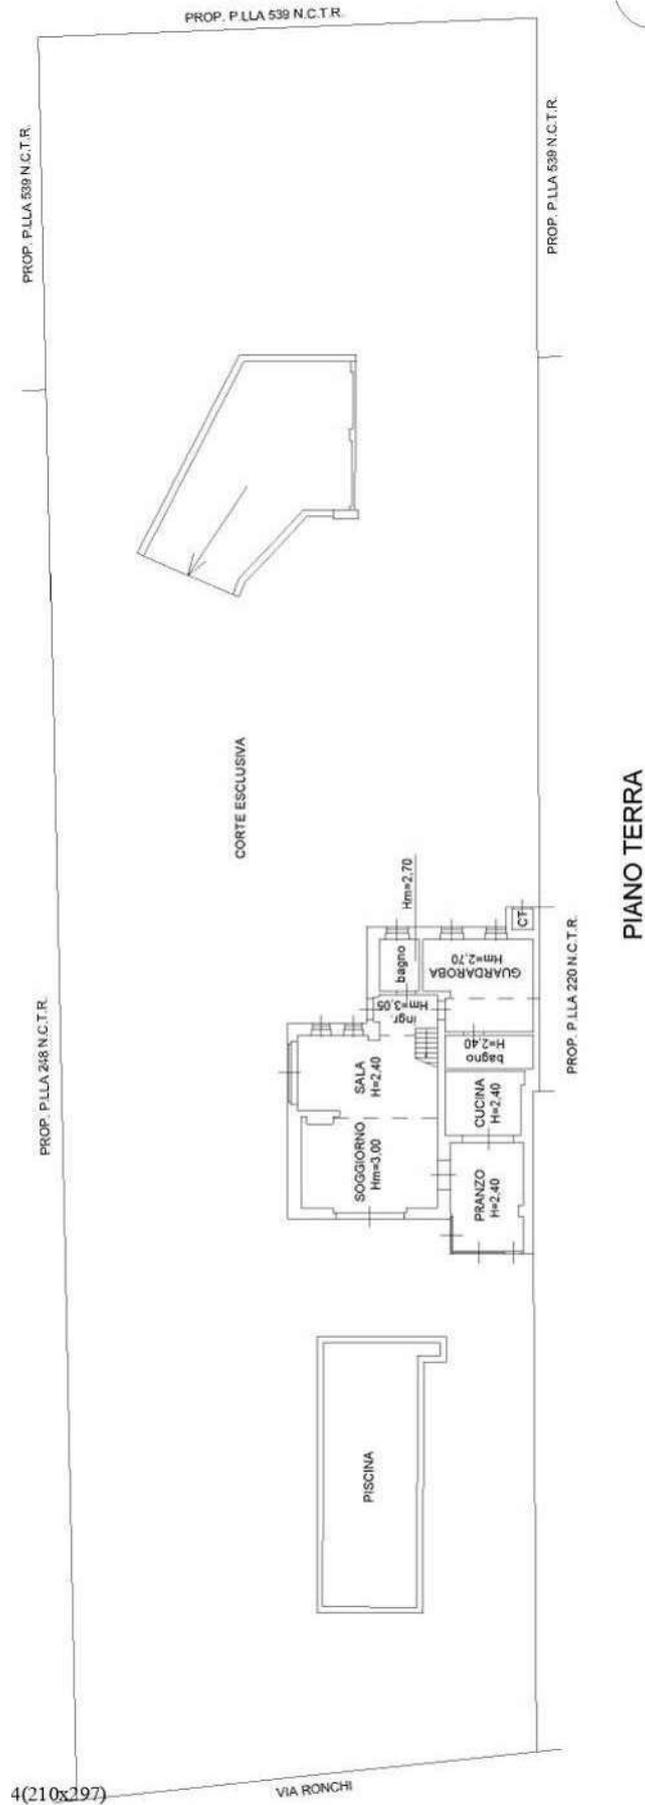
Stralcio planimetria VILLA – Fg. 9, particella 246 sub.4 – PIANO TERRA
